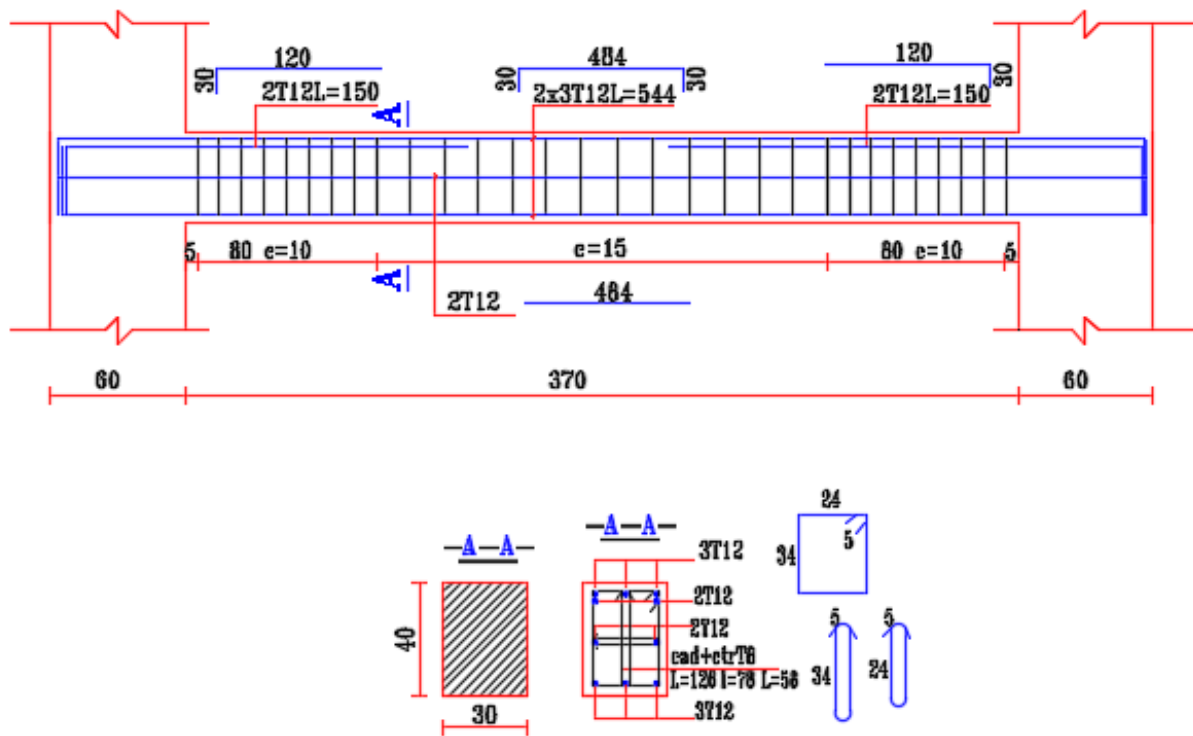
Schéma de ferrailage de la poutre palière :
